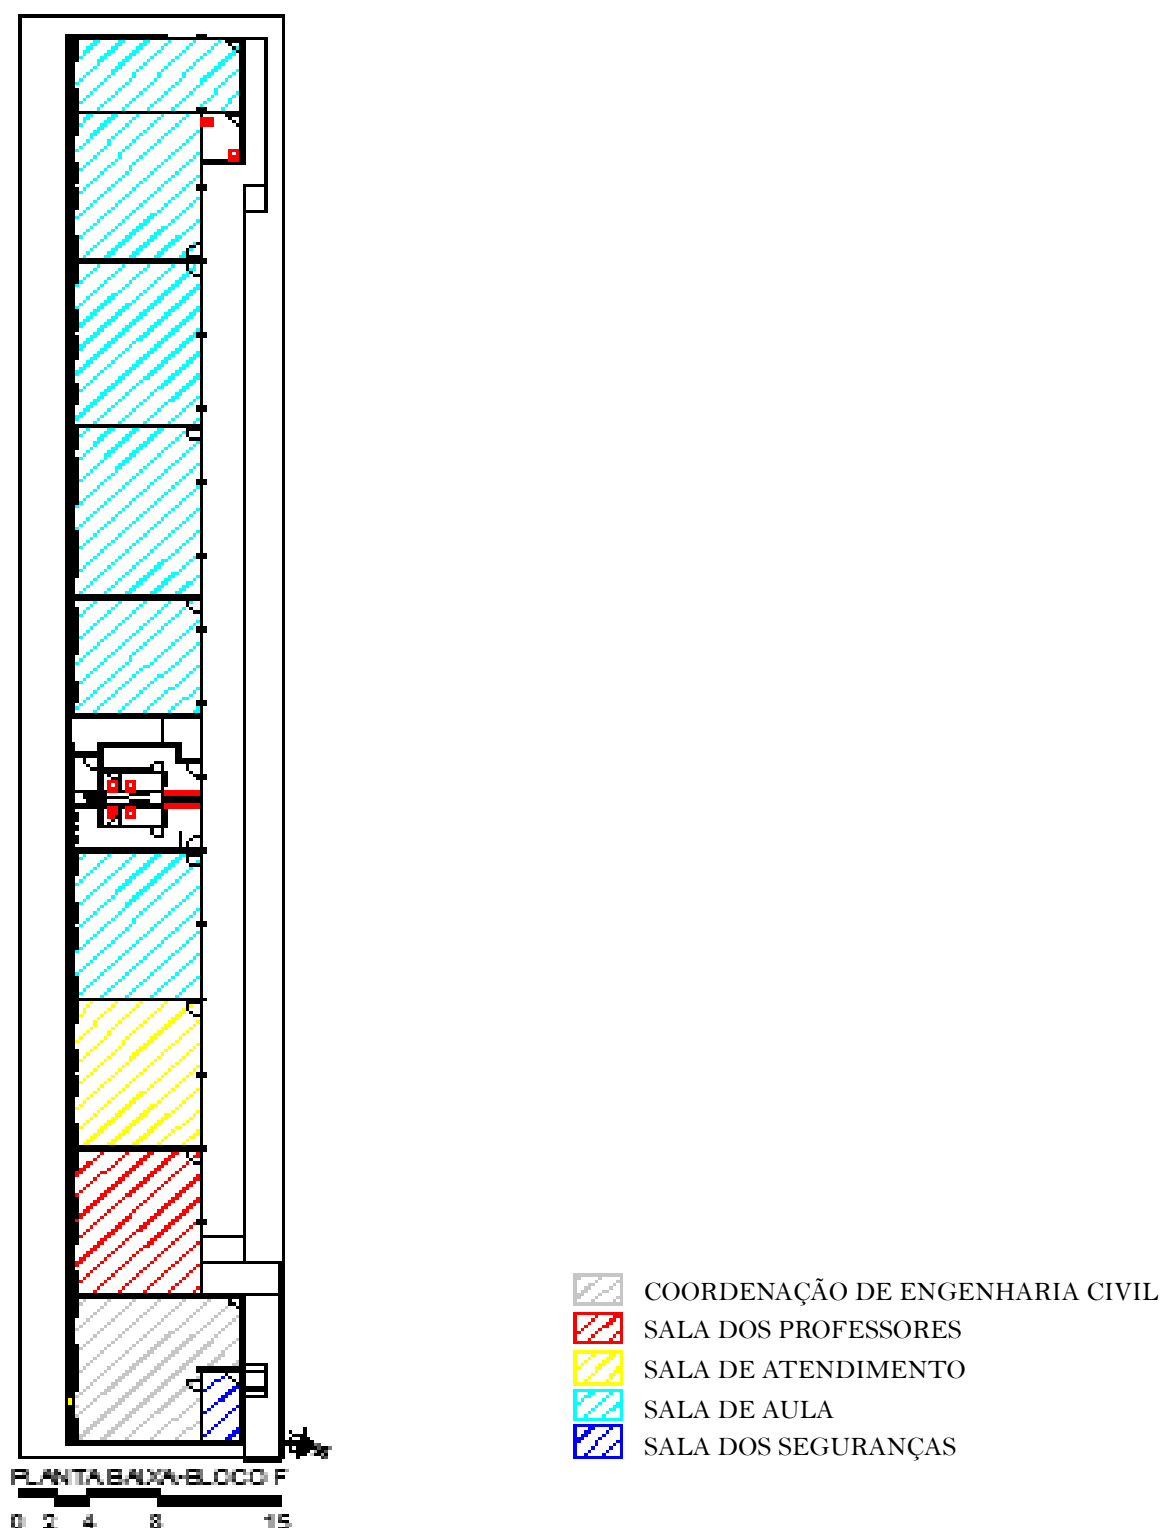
Planta de situação do bloco F de engenharia civil da quadra vermelha
